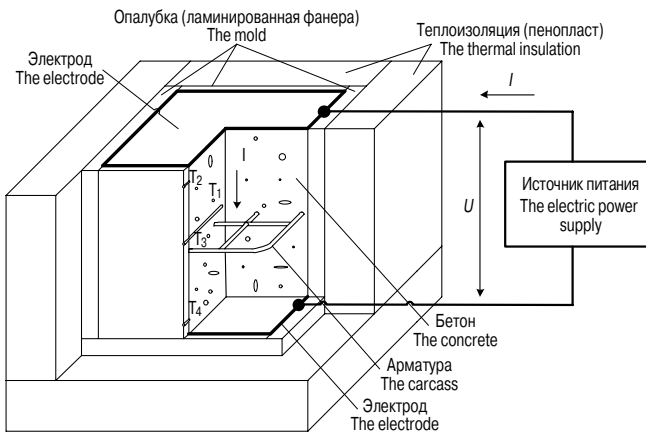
Схема электротепловой обработки стандартного образца 100×100×100 мм бетона В20 с макетом арматурной сетки
